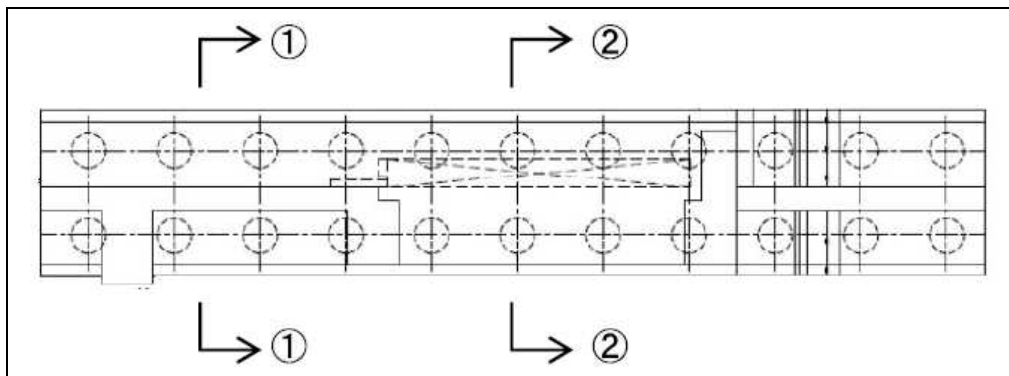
防潮扉平面図 (関西電力 高浜 1, 2 号炉)
